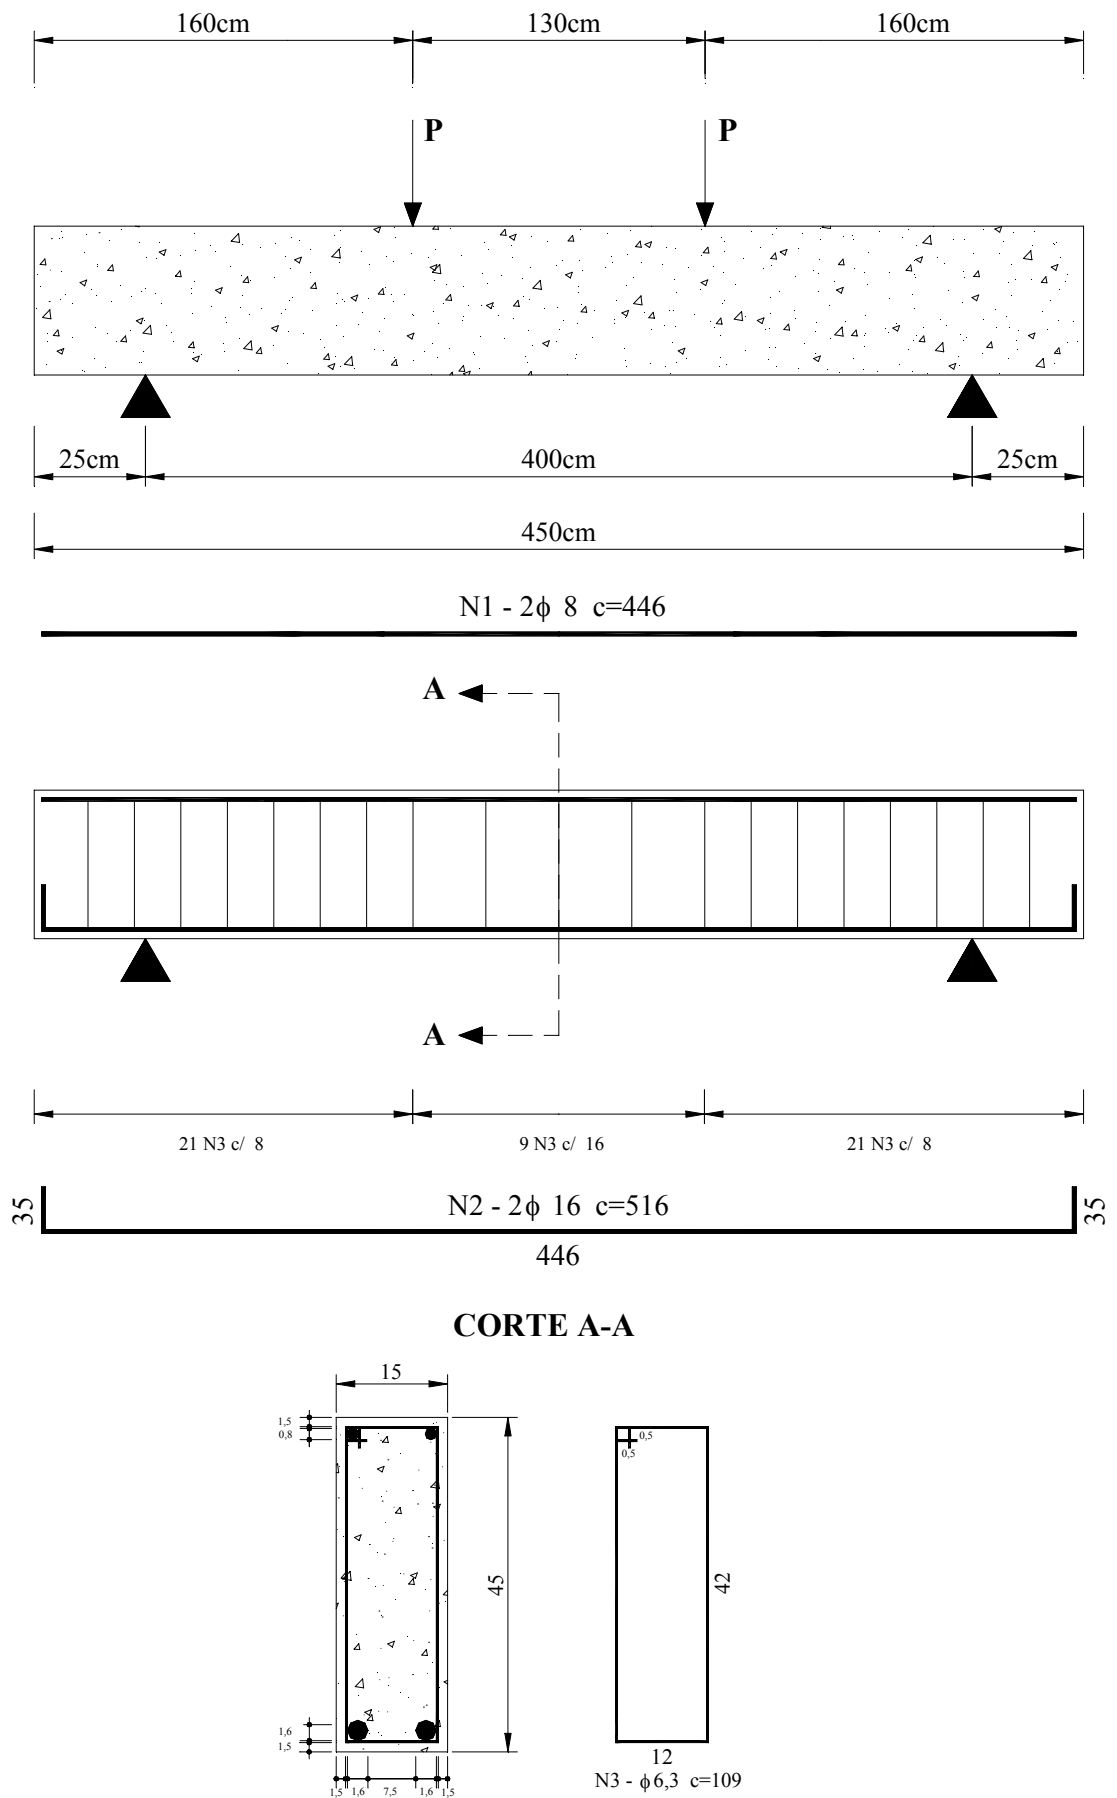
Detalhamento da viga 05 ensaiada por Ribeiro (1996)
